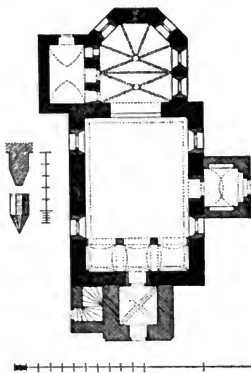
Drachau. Grundriss der Kirche, Gewölberippen und Konsolen im Presbyterium.
